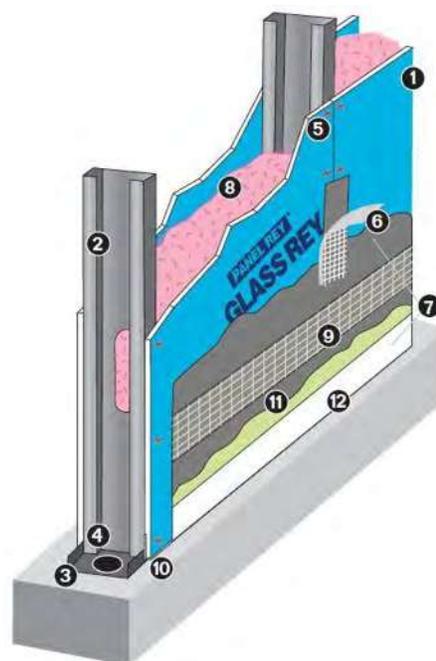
, SISTEMA CONSTRUCTIVO DEL PANEL REY, FUENTE: FICHA TÉCNICA DEL PANEL REY, [[http://www.panelrey.com/cat\\_paneles.html](http://www.panelrey.com/cat_paneles.html)], 25.03.13]
